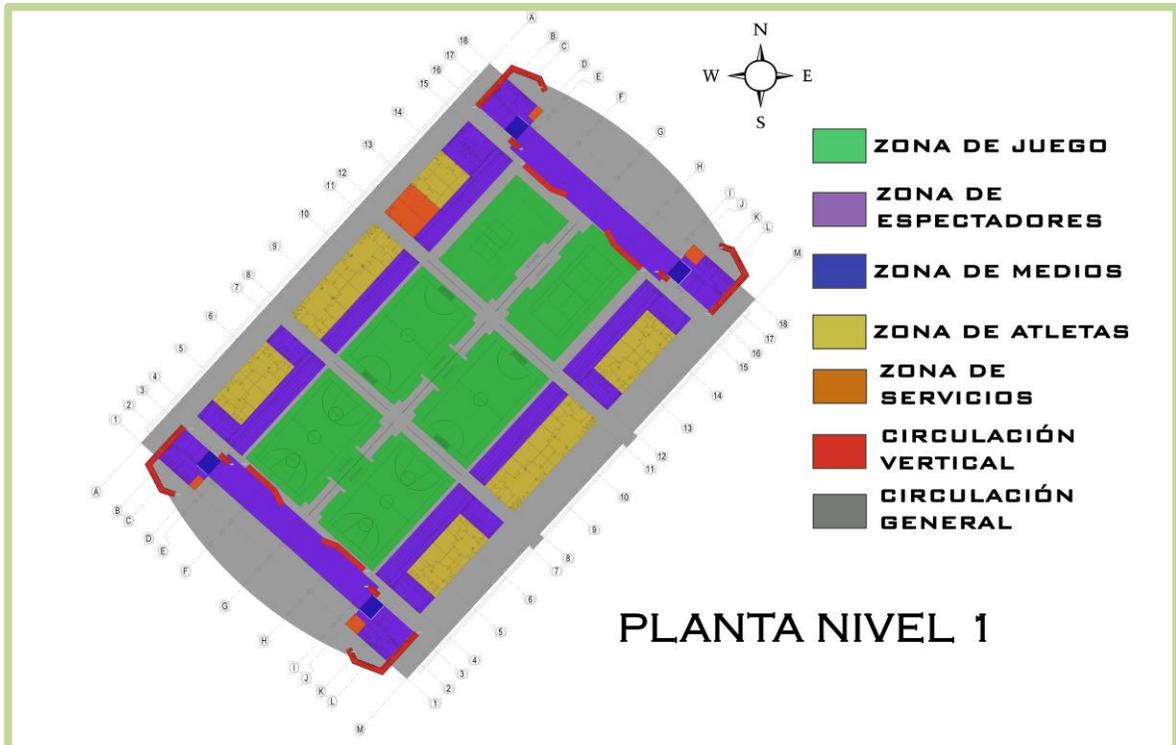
Zonificación coliseo - planta nivel 1 - Fuente: Elaboración propia
